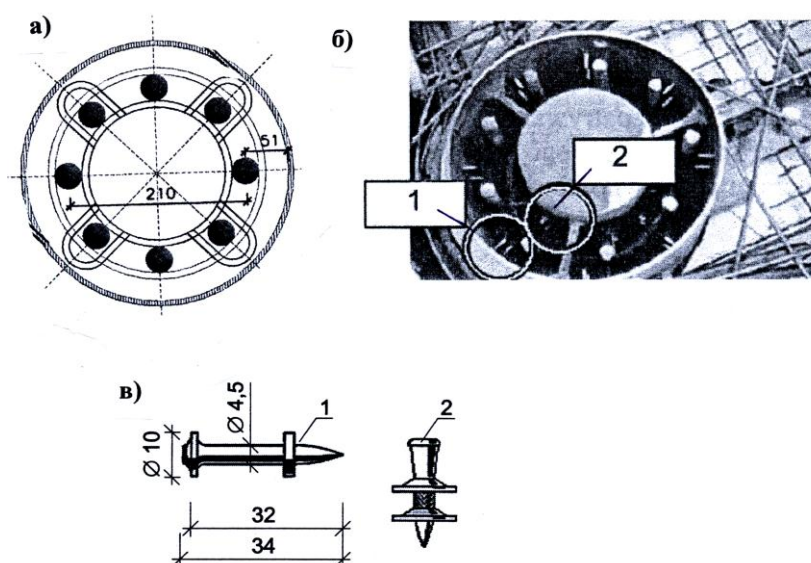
Пример размещения пристреливаемых анкерных дюбелей 1 и 2 в трубобетонной колонне, армированной гибкими стержнями и жестким сердечником в виде трубы [4]
